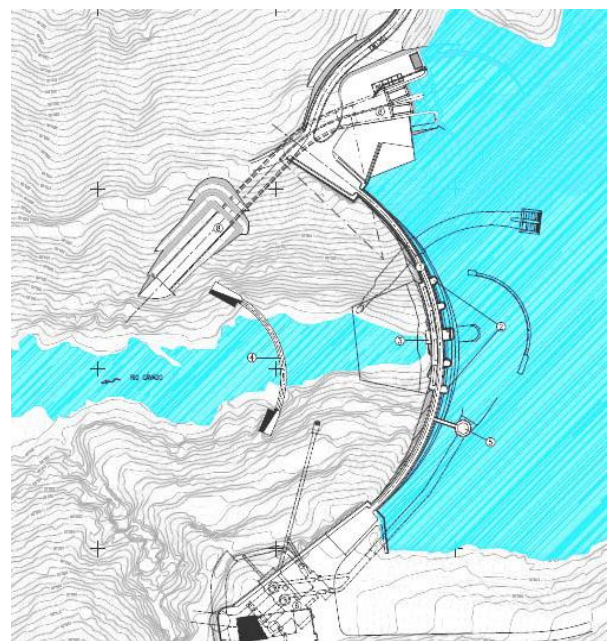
Vista em planta da barragem de Salamonde e da intervenção realizada – DCC (LNEC, 2012).
